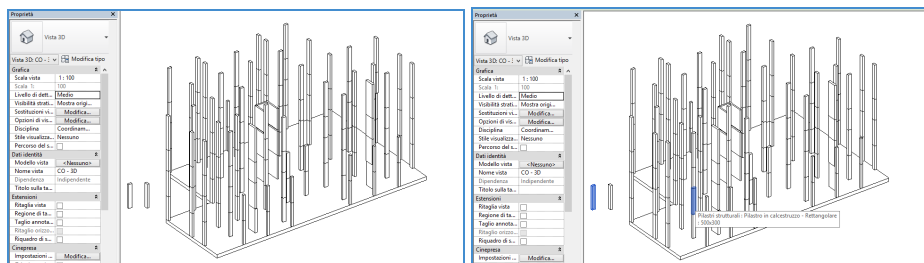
Input delle caratteristiche strutturali dei pilastri
